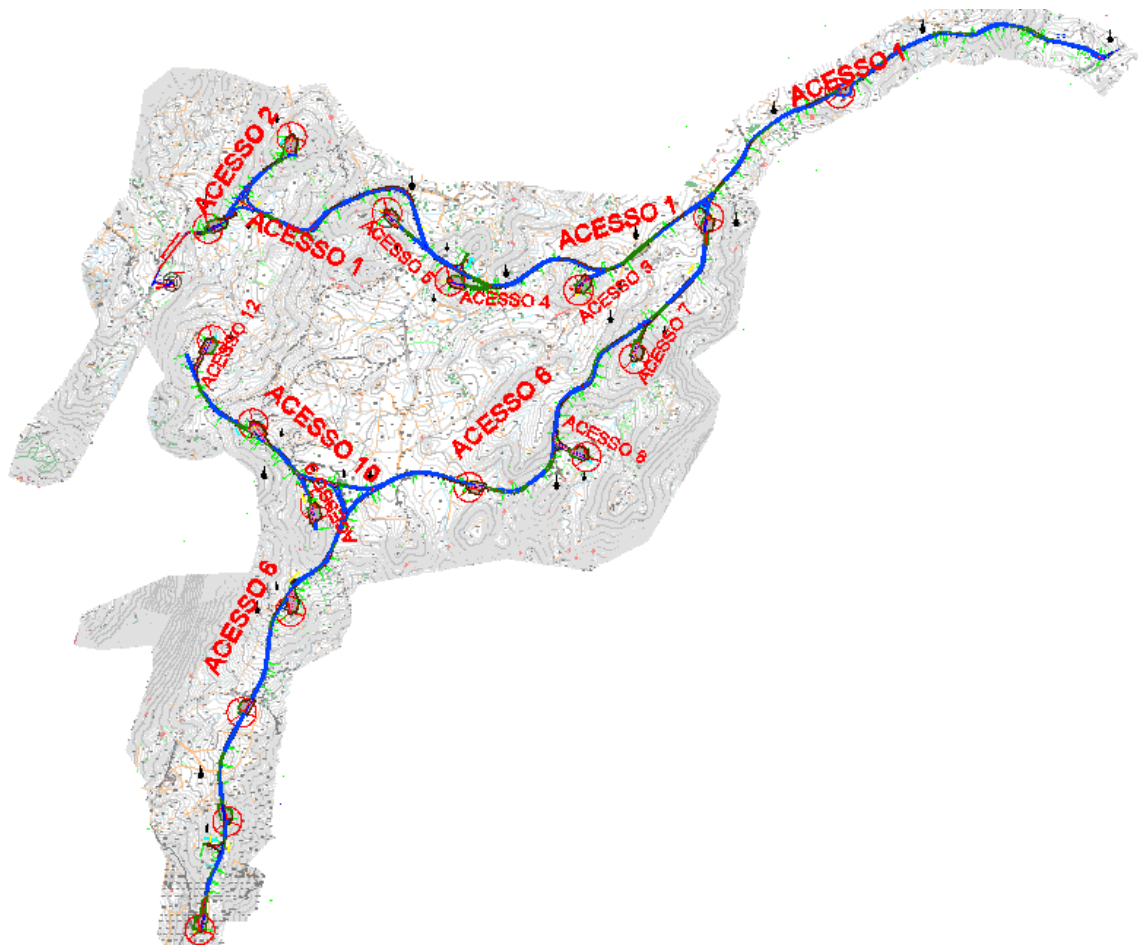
PLANTA DE ACESSOS - NÚCLEO DE S. GENS (FONTE: PROJECTO DE EXECUÇÃO)
